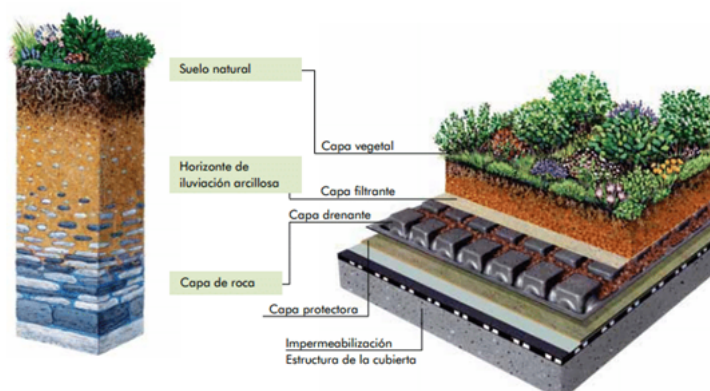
Imagen del esquema constructivo de una cubierta verde plana (Ovacen (2023))
